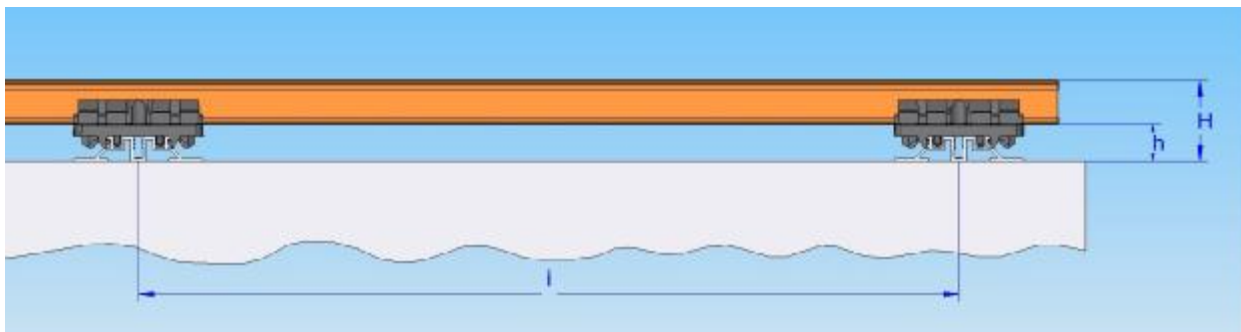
sezione longitudinale dei listoni in legno fissati su sottostruttura in alluminio KIT 40 ad altezza fissa
